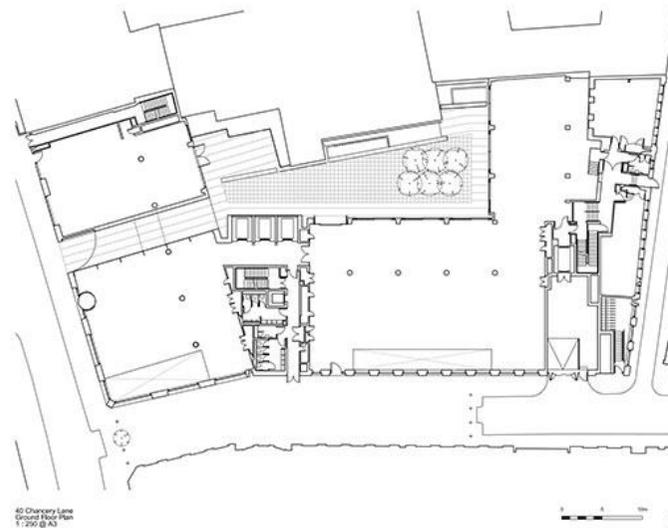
Planta donde se aprecia el patio interior y el atrio
